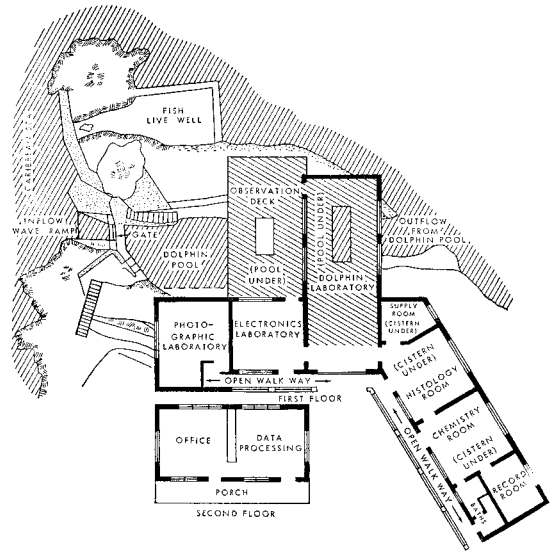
Grundriss des Dolphin Point Laboratory auf St. Thomas
